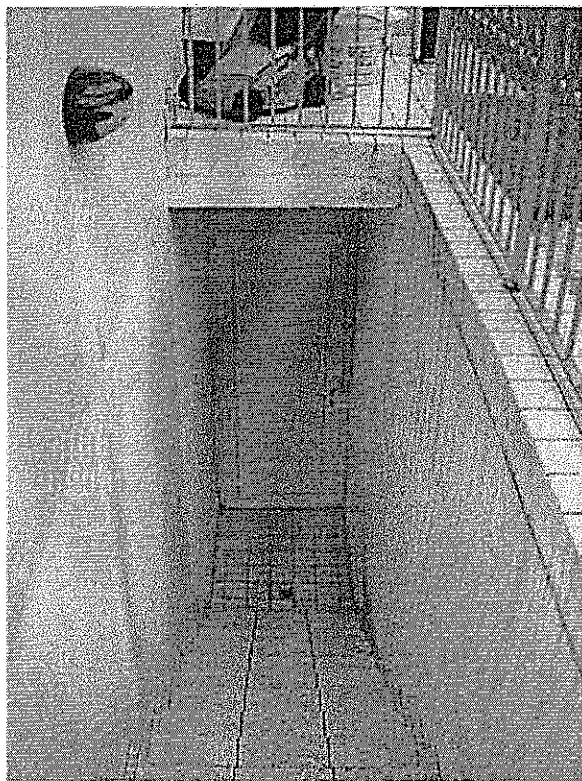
Vista del vano scala che collega il garage di cui al M.N. 1771 sub 18 all'area scoperta ad uso esclusivo di cui al M.N. 1771 sub 20.
